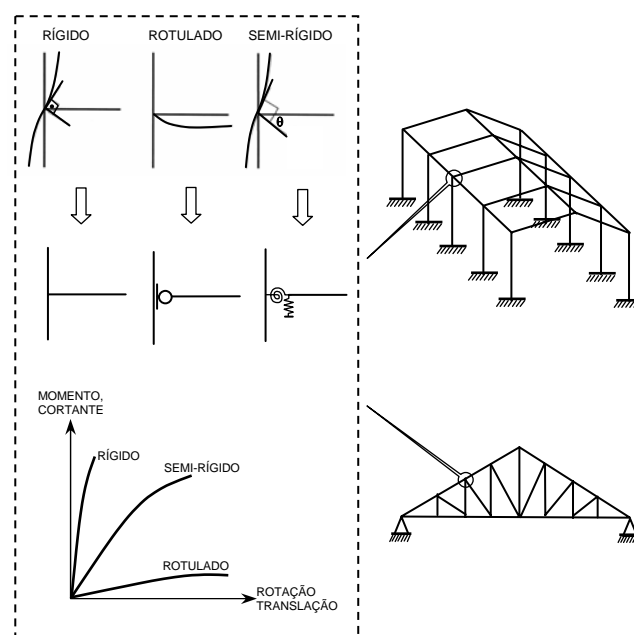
Comportamento das ligações em estruturas reticuladas.
